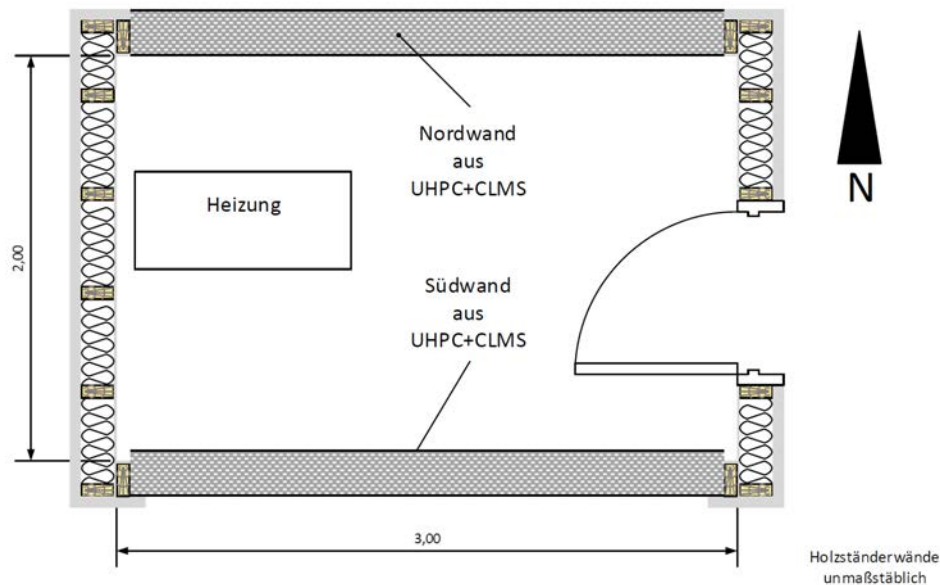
Grundriss des Demonstrators.
